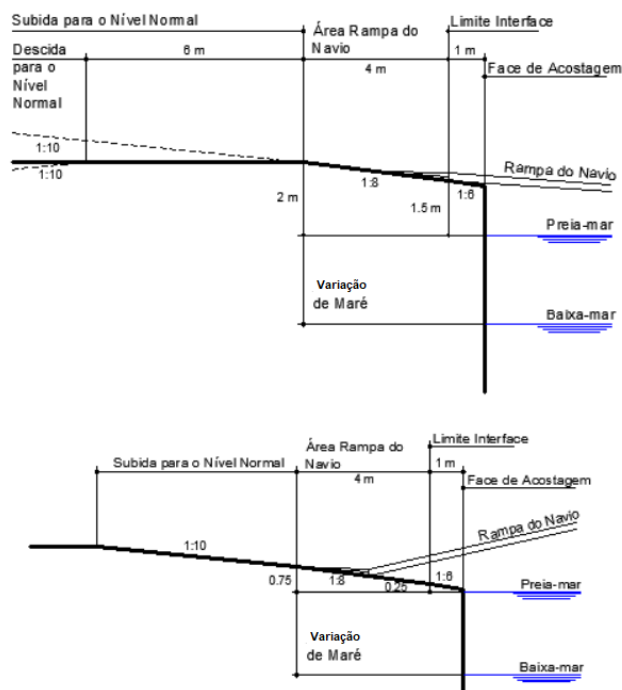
Disposições construtivas para rampas fixas - Fonte: Adaptado ISO:6812:1983, 1983
